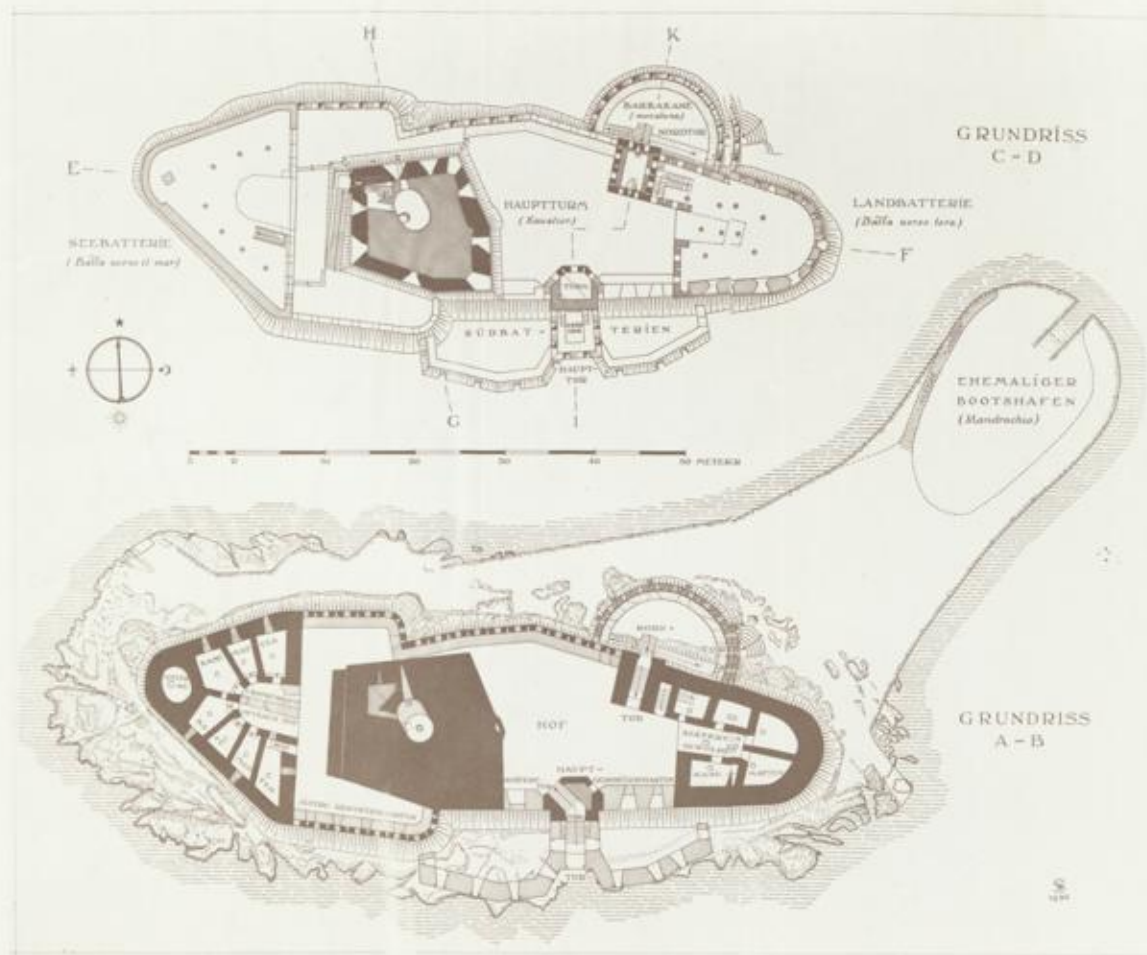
, vor S. 95. Das Inselkasteil (Grundrisse)
